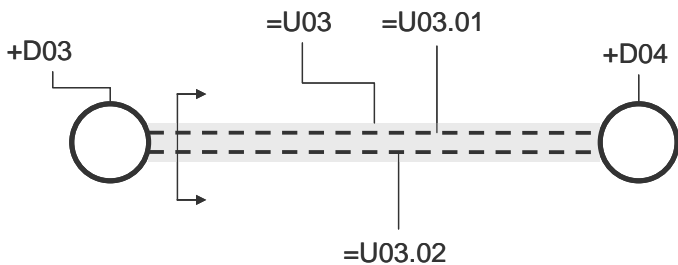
visar tvärsnitt av tunnel. Tunneln betecknas =U03.
